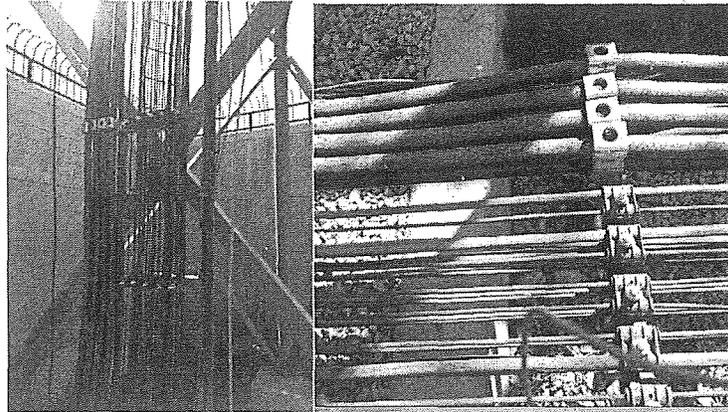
Guías de onda, camas de cables y cables sujetos con Hangers
